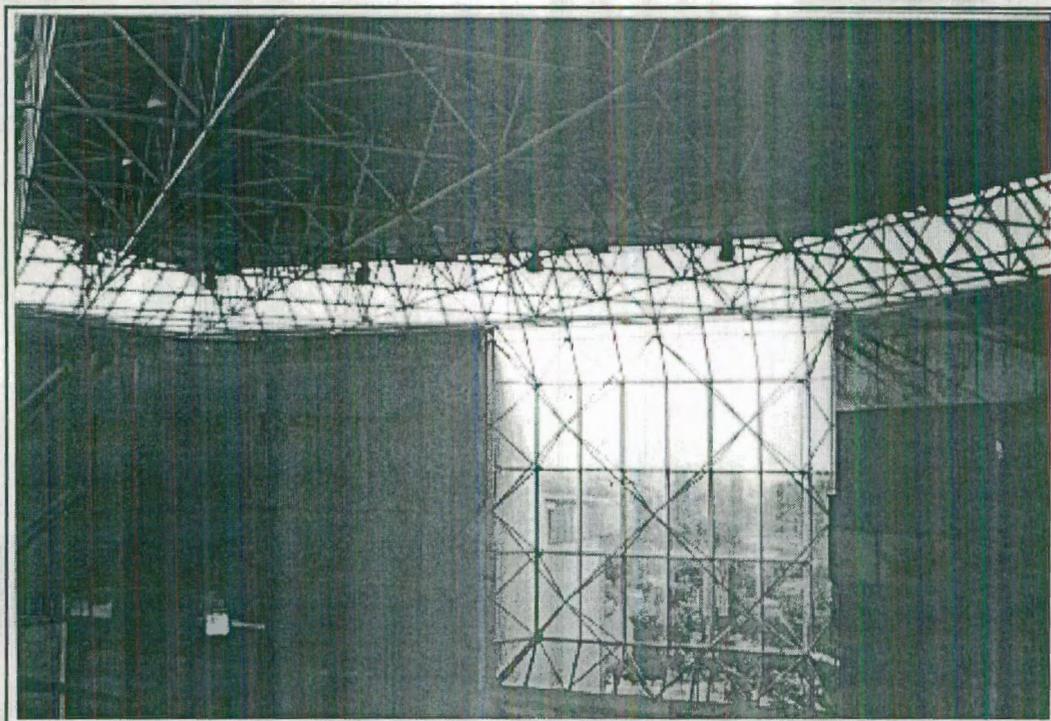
Estado de pintura en paredes de fachada lateral en zona de Apoyo Administrativo.
